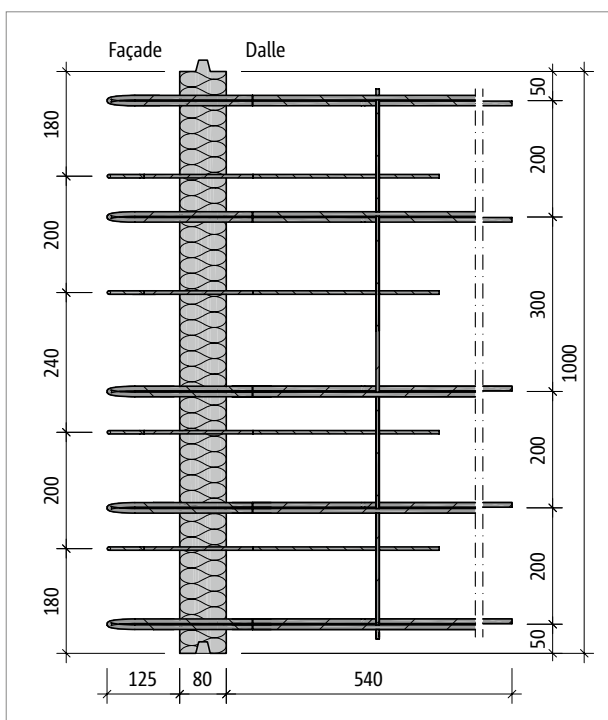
Schöck Rutherma® T type DF-V3-LR125 : vue en plan du produit
